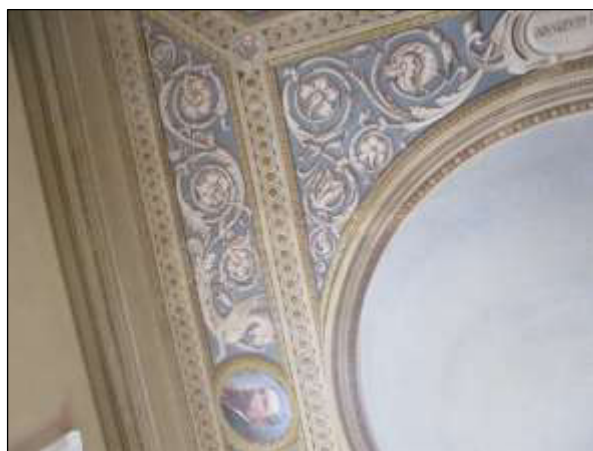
Porzione del plafone della Sala Giunta al primo piano connotata da un eccessivo distacco della finitura.
